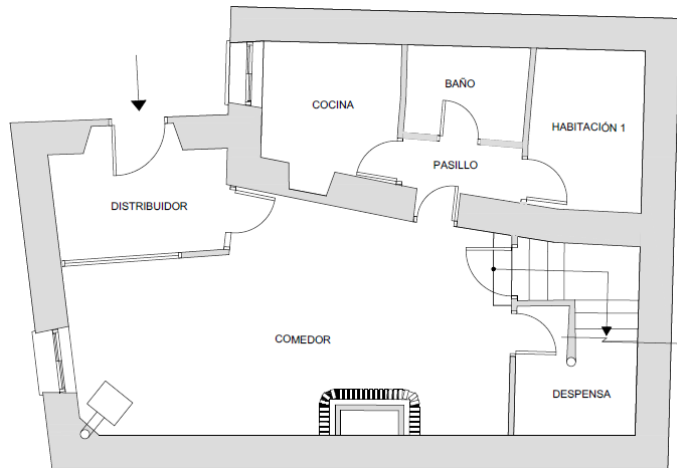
Plano de distribución de planta baja. Fuente: Autor.
